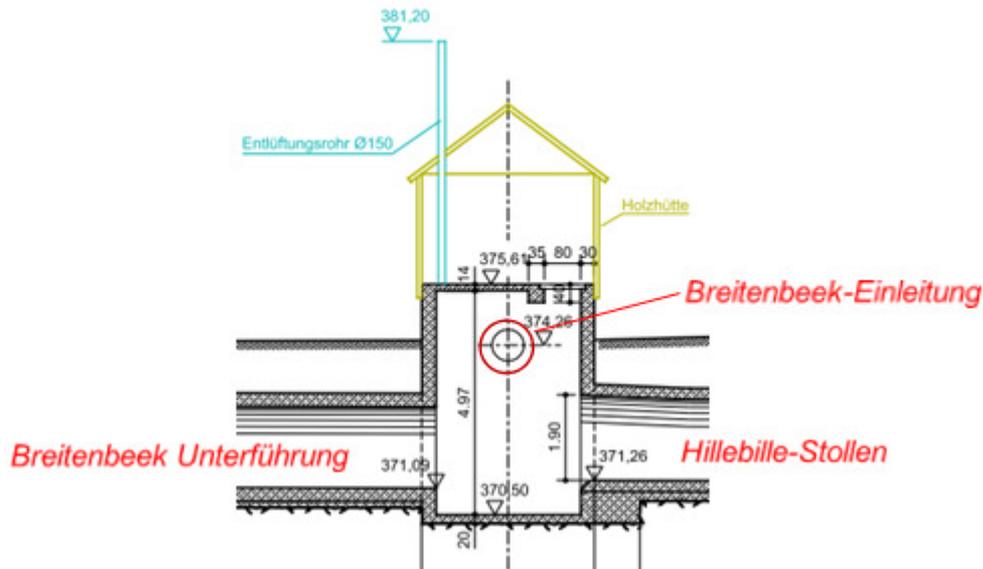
Hillebille-Stollen Einlaufbauwerk Querschnitt
